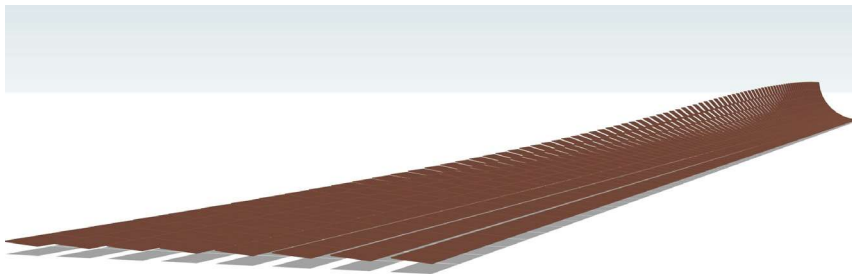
Impressie van de zonnewand en overgang vanaf aansluiting Hoogeveen-Oost
